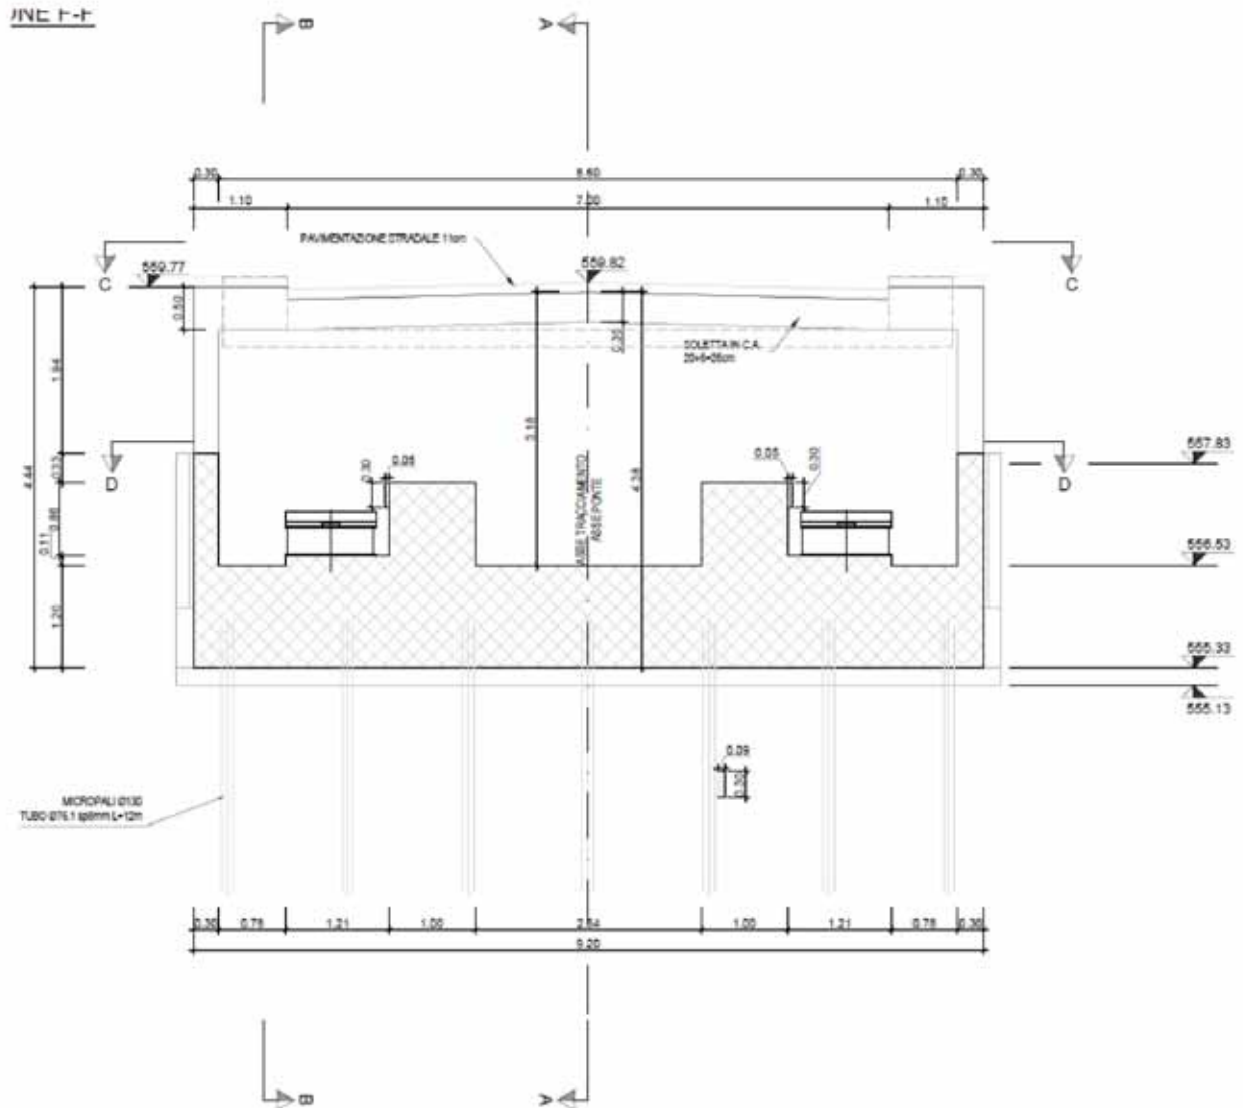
SPALLA A – Sezione longitudinale
